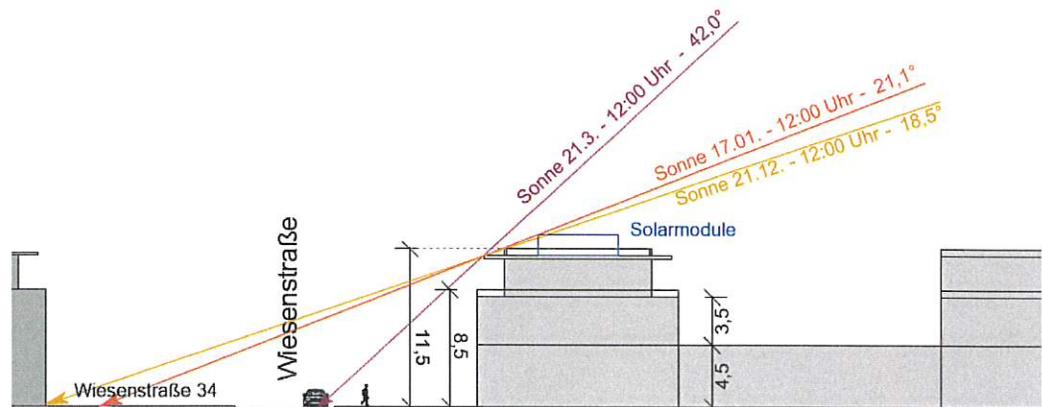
Skizze der geplanten Bebauung – Ansicht von Nord-Westen
